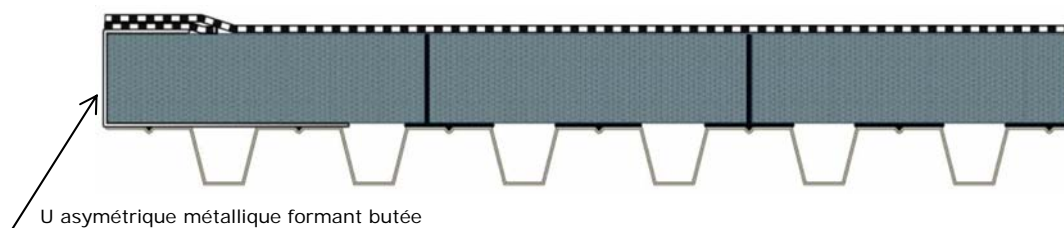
Coupe de principe sur rive sans acrotère, sur élément porteur métallique
